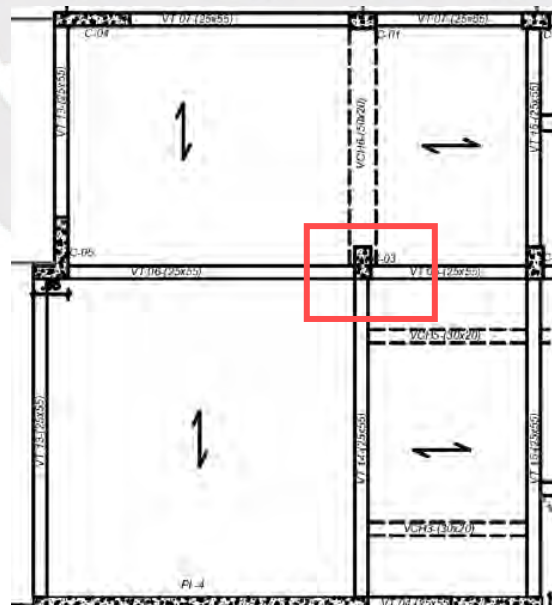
Ubicación de la columna entre los Ejes B y 5
